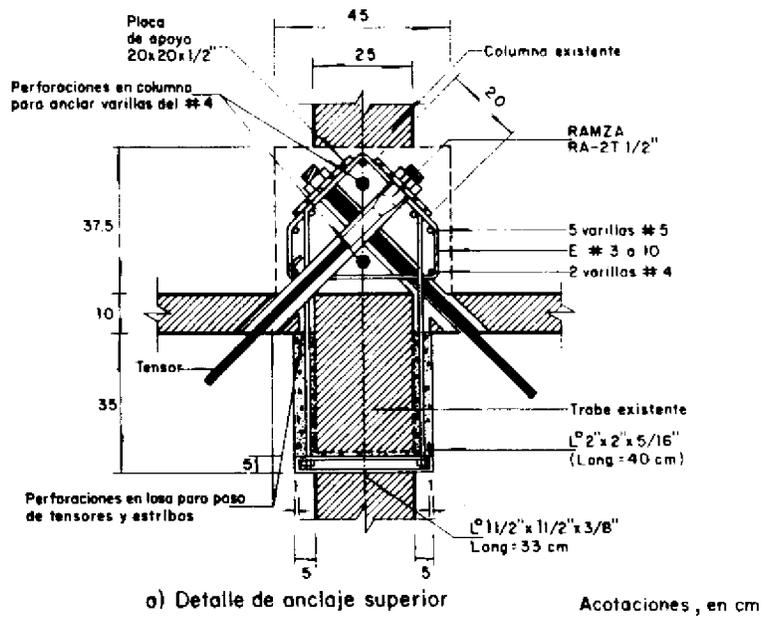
Detalles de anclaje de cables de refuerzo (tomado de la ref. 22)
